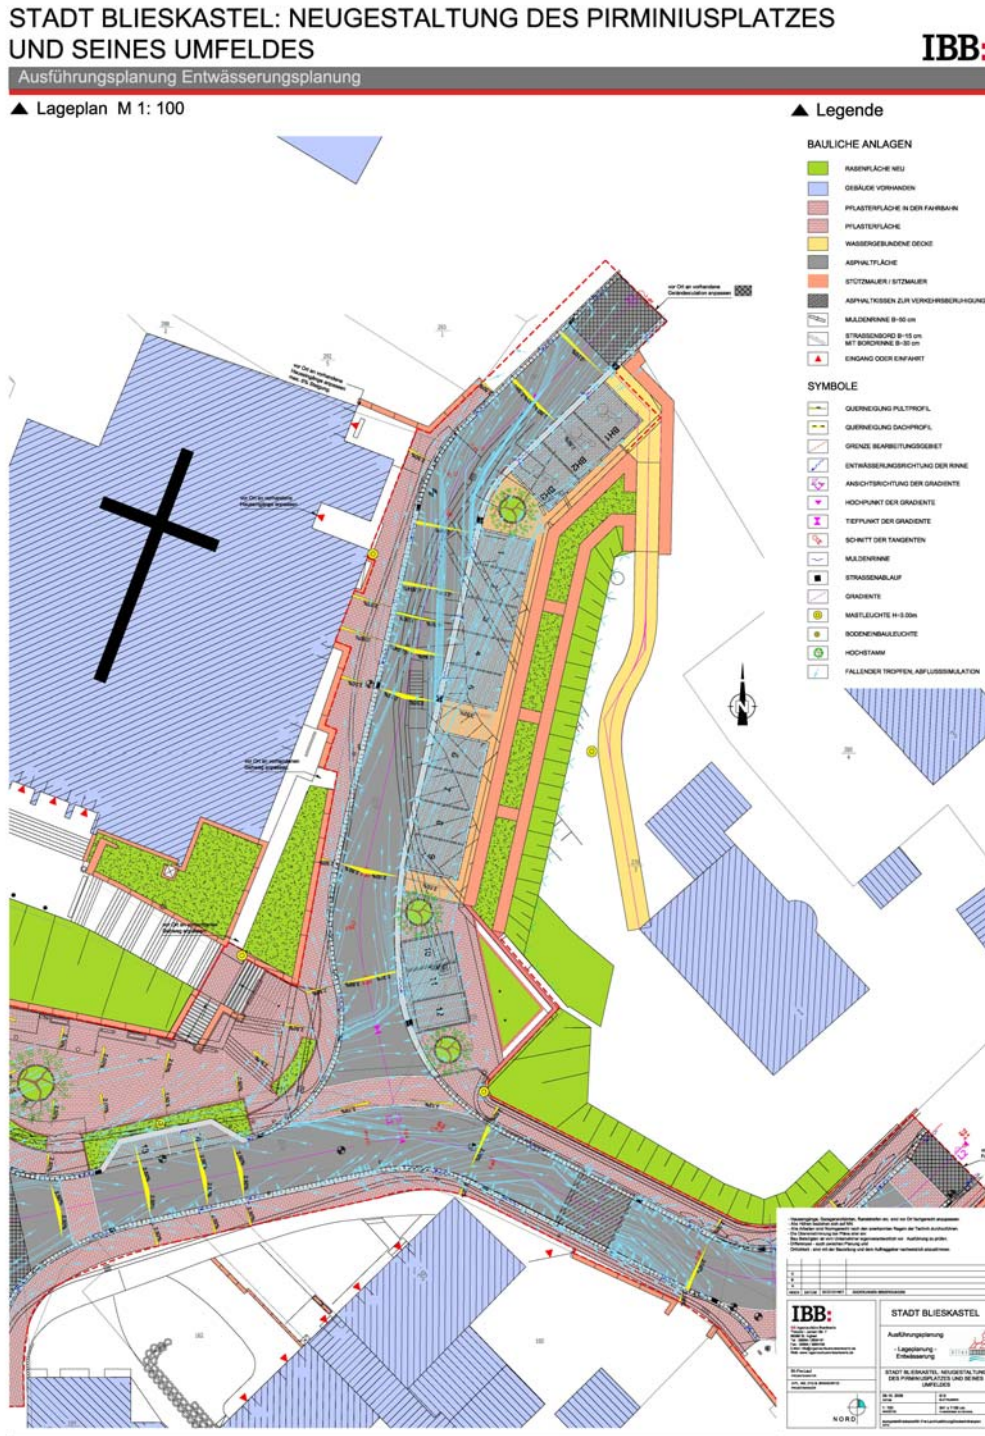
Entwässerungsplan mit Oberflächenabfluss Simulation
